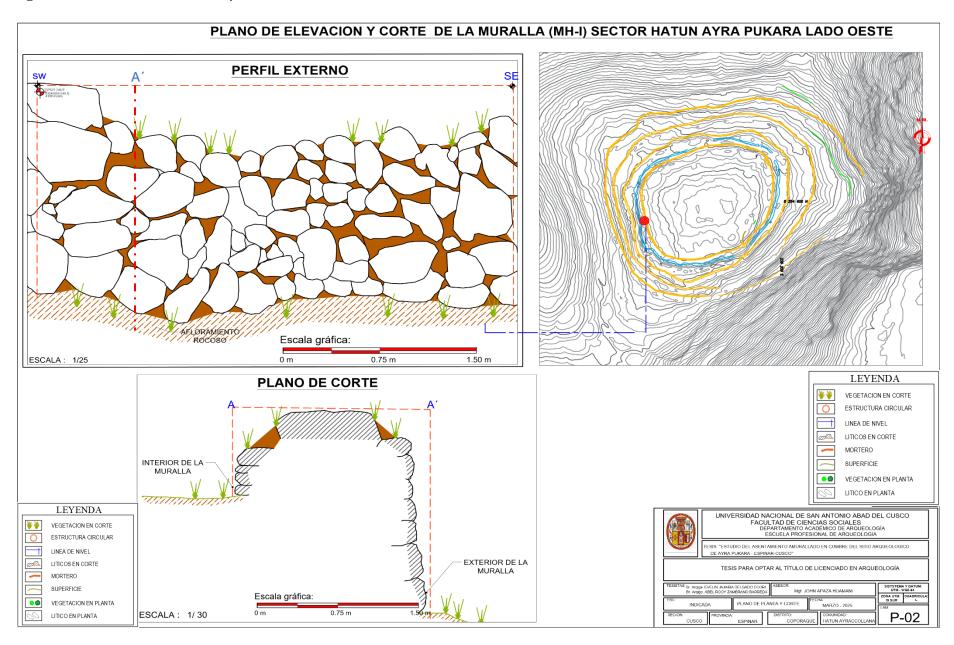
Plano de elevación y corte de la muralla, lado Oeste
